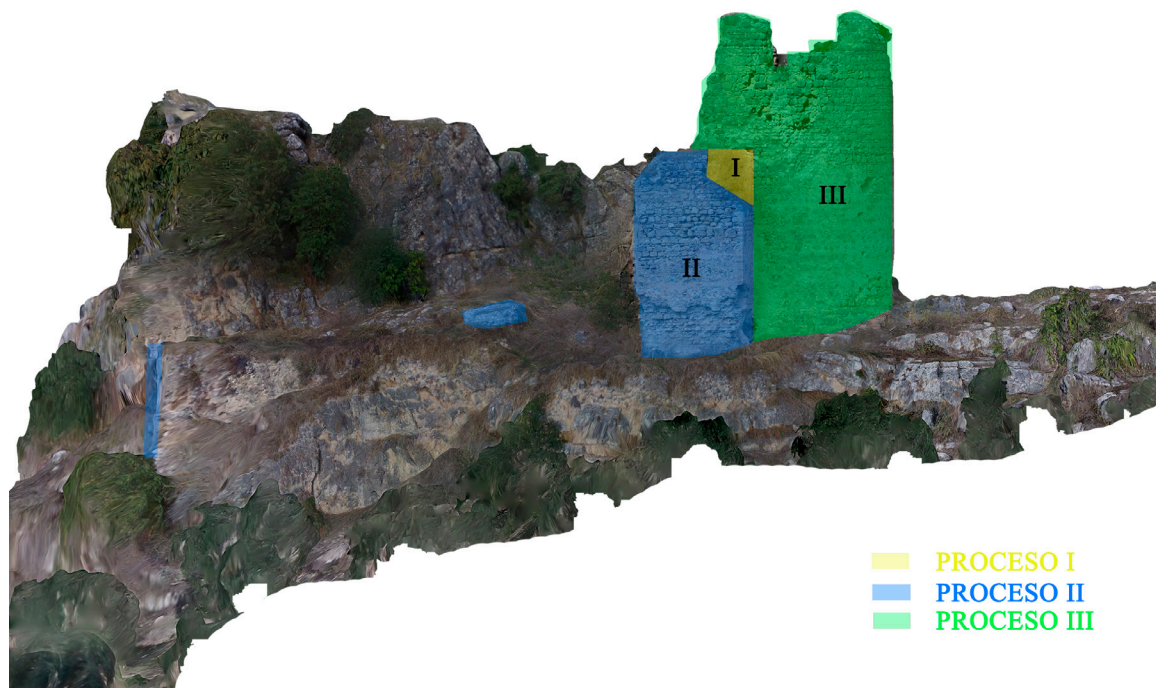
Imagen de estructuras relacionadas a procesos constructivos vista desde el sur.
